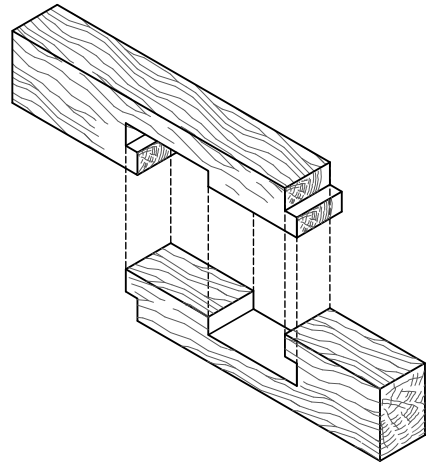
Detalle de unión empalme de llave con traba o con encaje interior utilizado en Chiloé.
